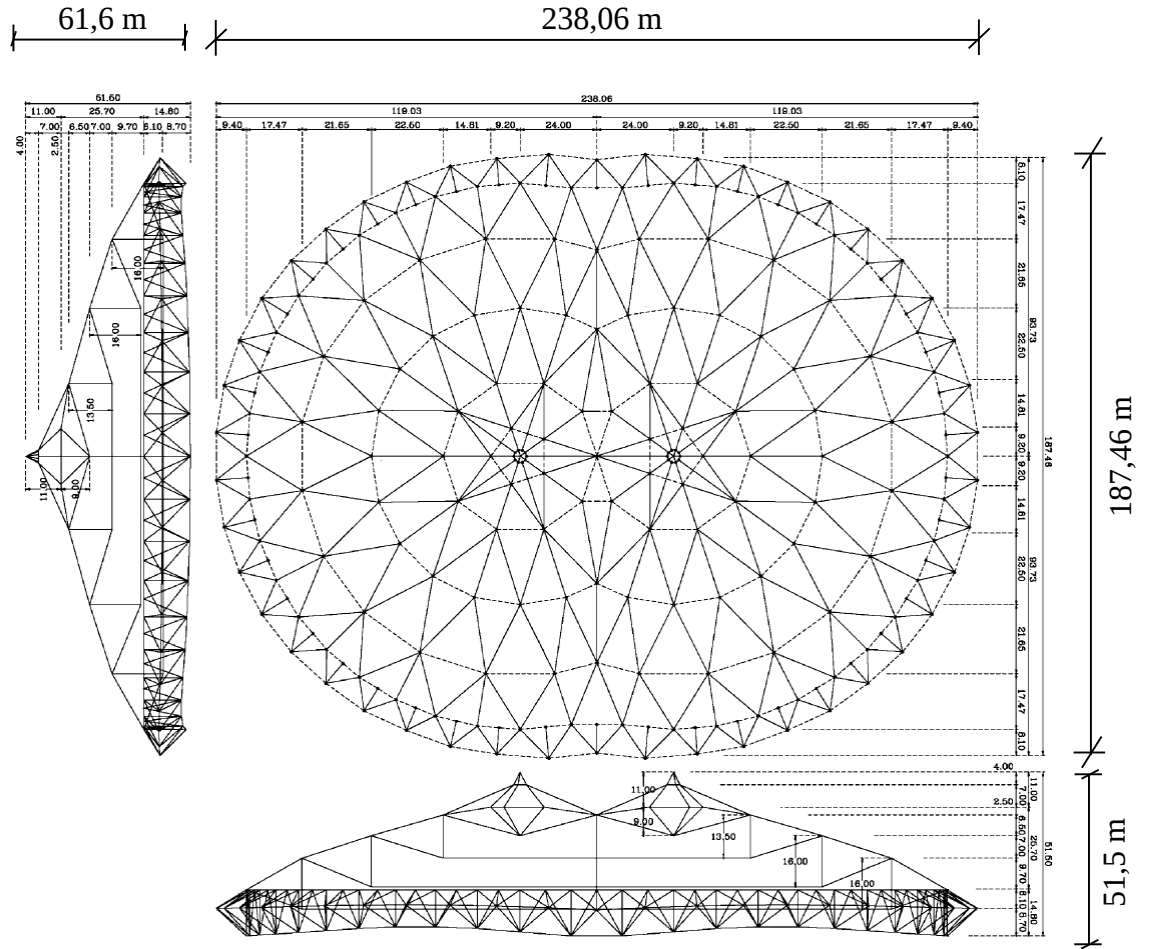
Stadyum planı (Archdaily, 2011)
